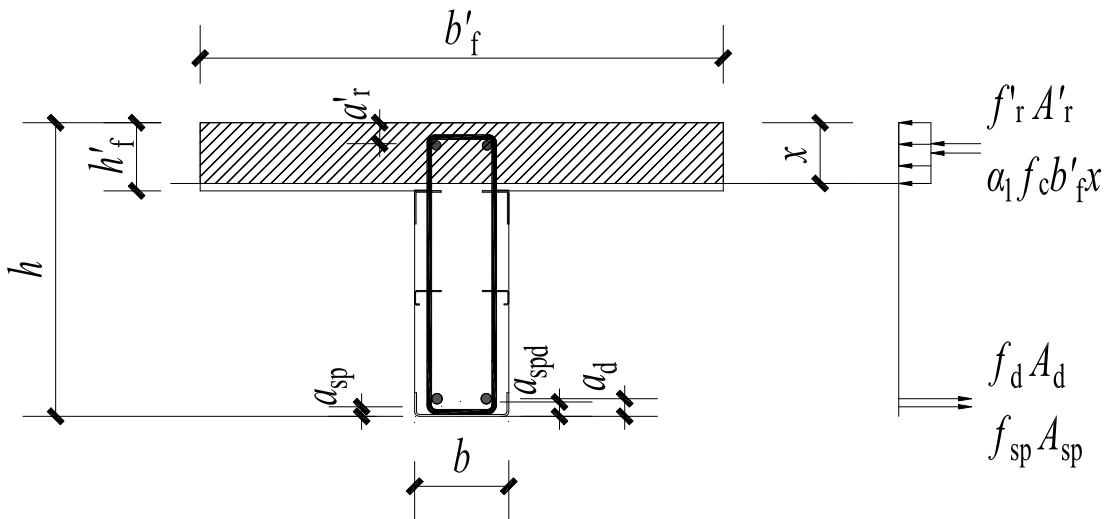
中和轴位于混凝土板内时连梁受弯承载力计算参数示意图
